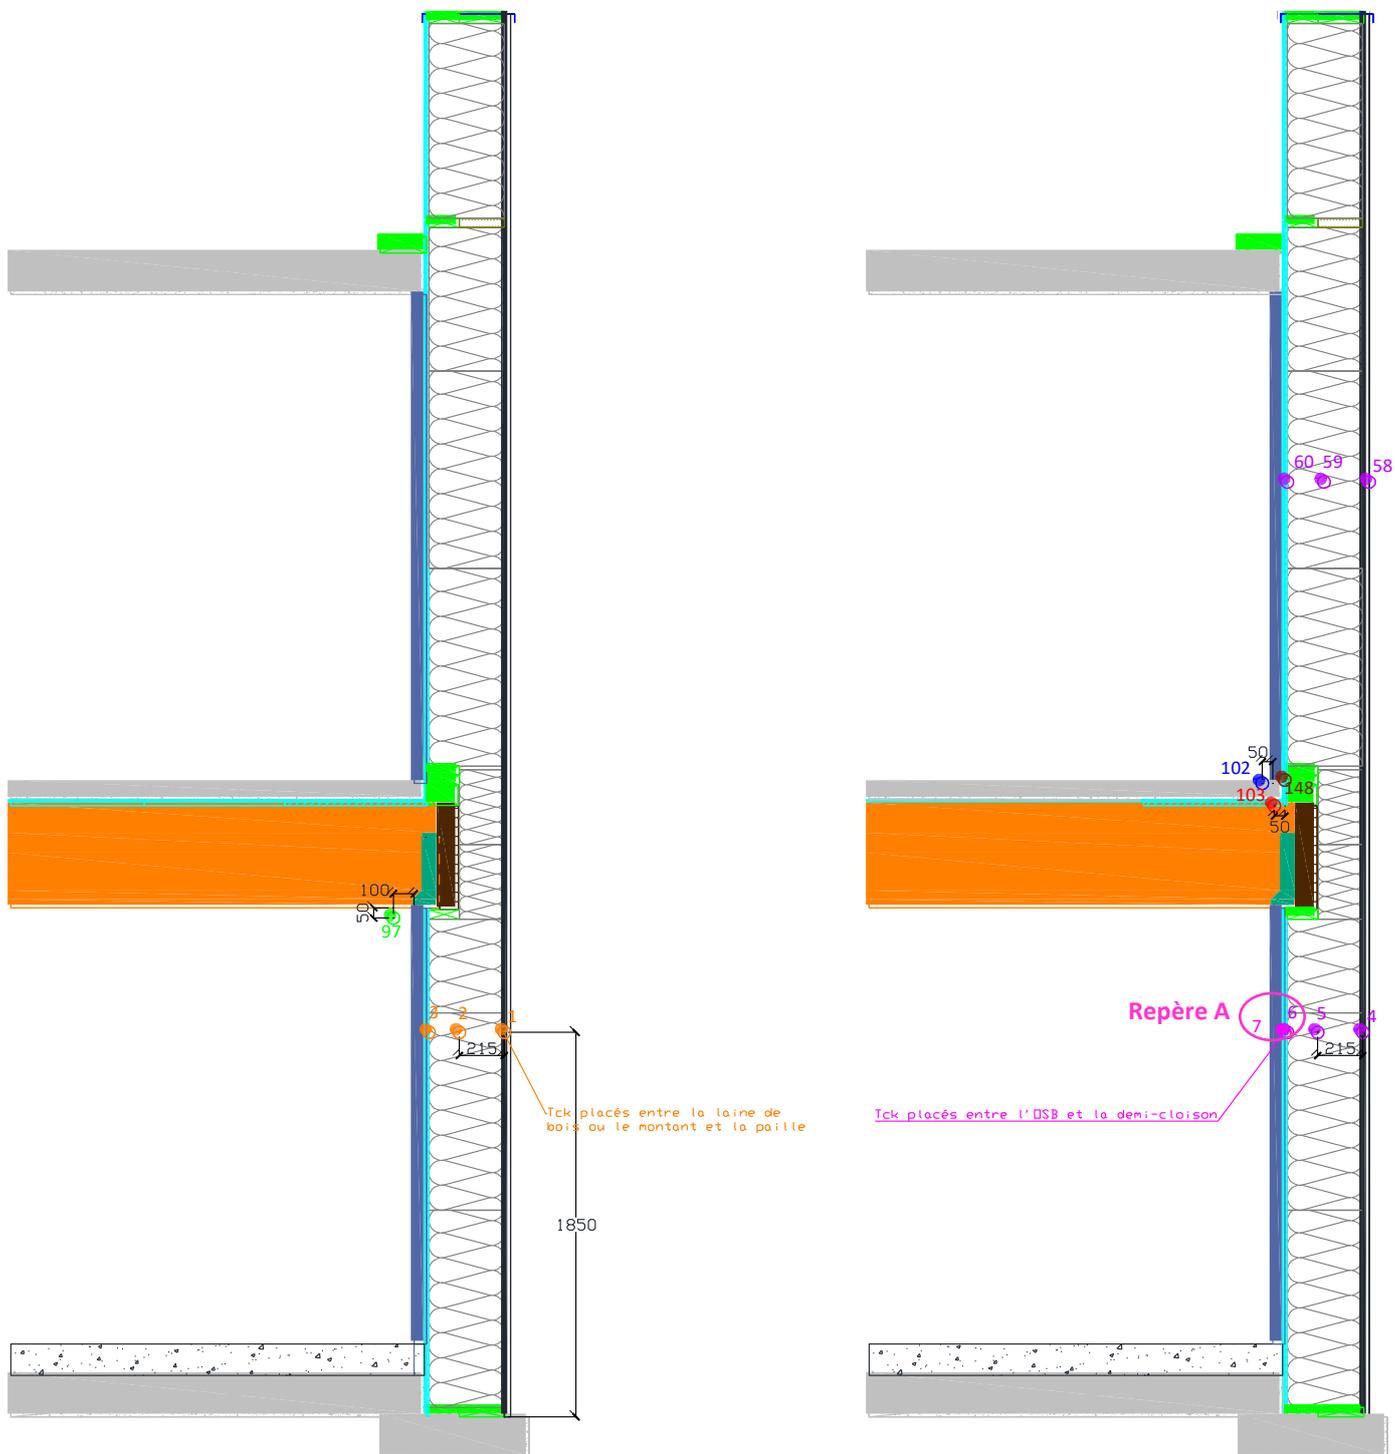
Instrumentation de l'élément de façade - (A gauche) : Coupe A-A - (A droite) : Coupe B-B
